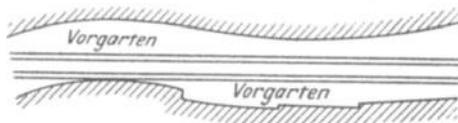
Gekrümmte Straße mit geradem Fahrdamm.
